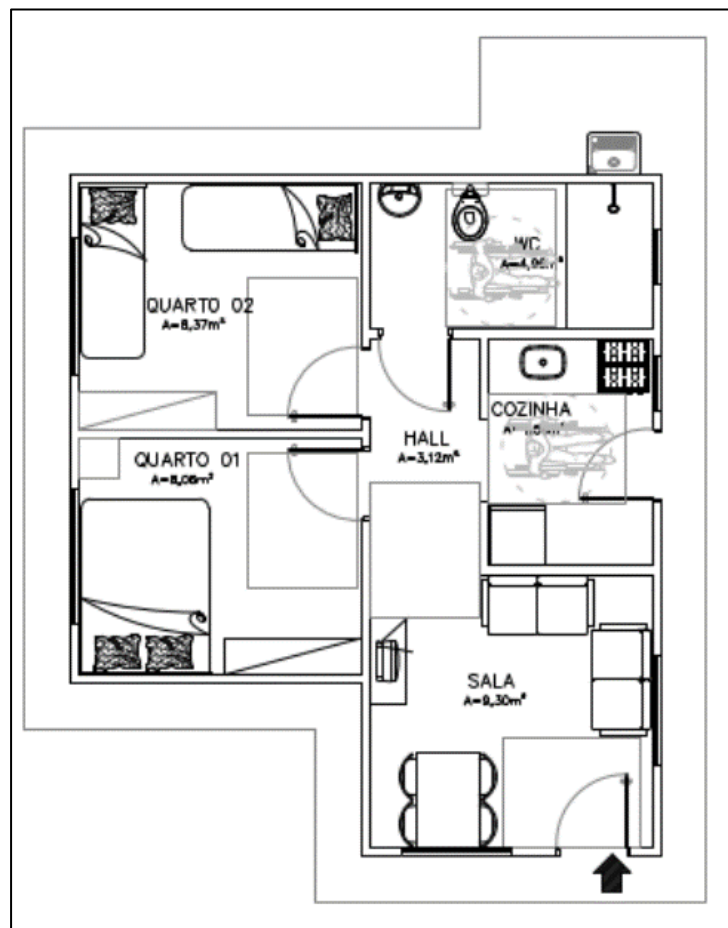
Planta baixa do padrão Casa Verde Amarela do Governo Federal.
